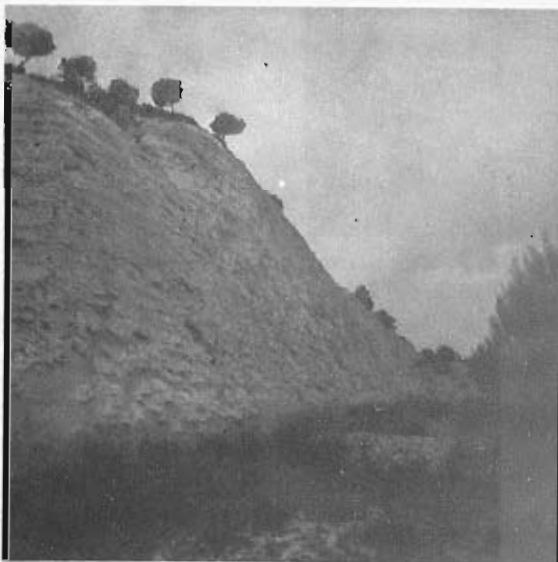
Talud artificial del ferrocarril abandonado Alicante - Alcoy, tallado en las margas del grupo 32m. (Cuadrante 846—2).
